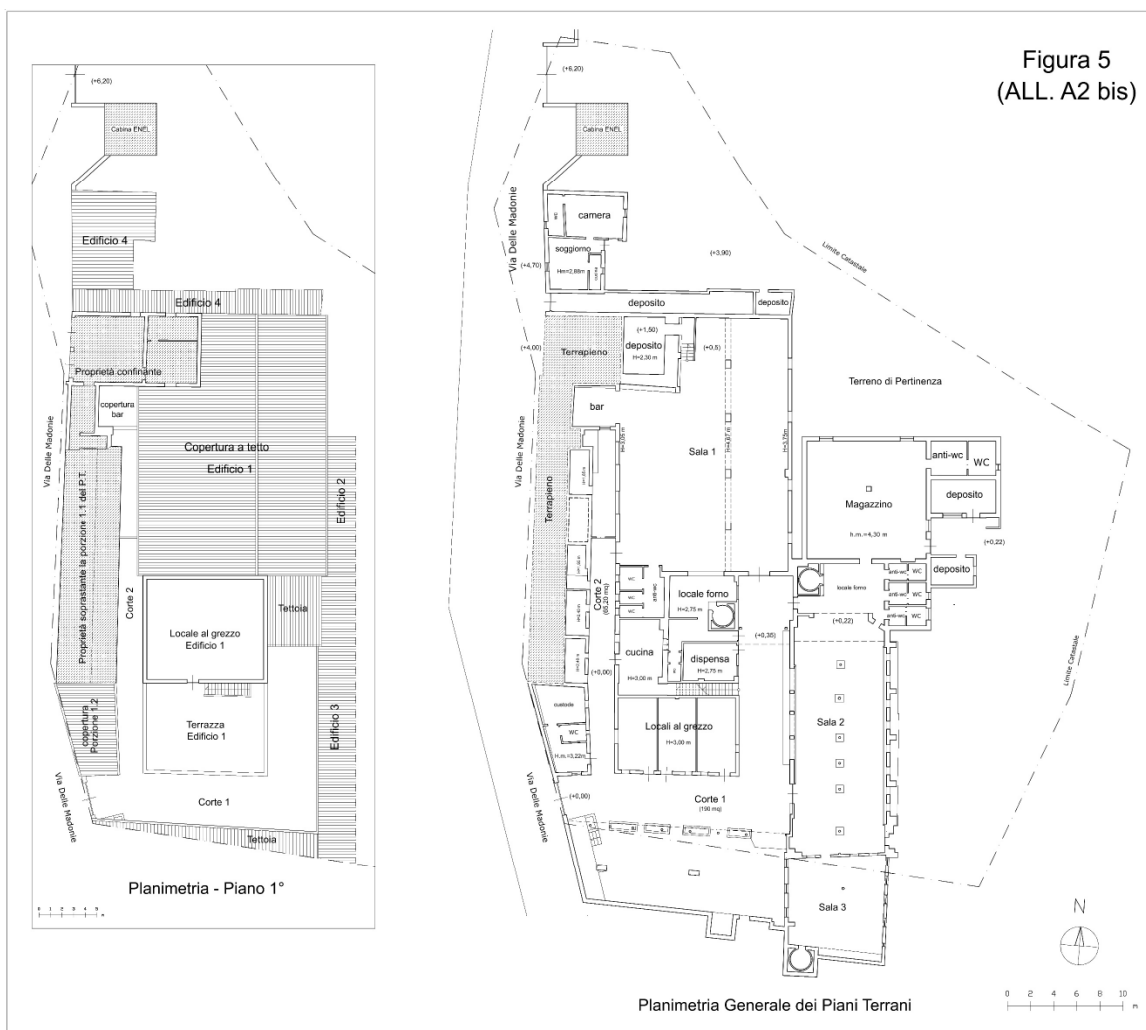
Planimetrie Generali Piano Terra e Piano Primo.
